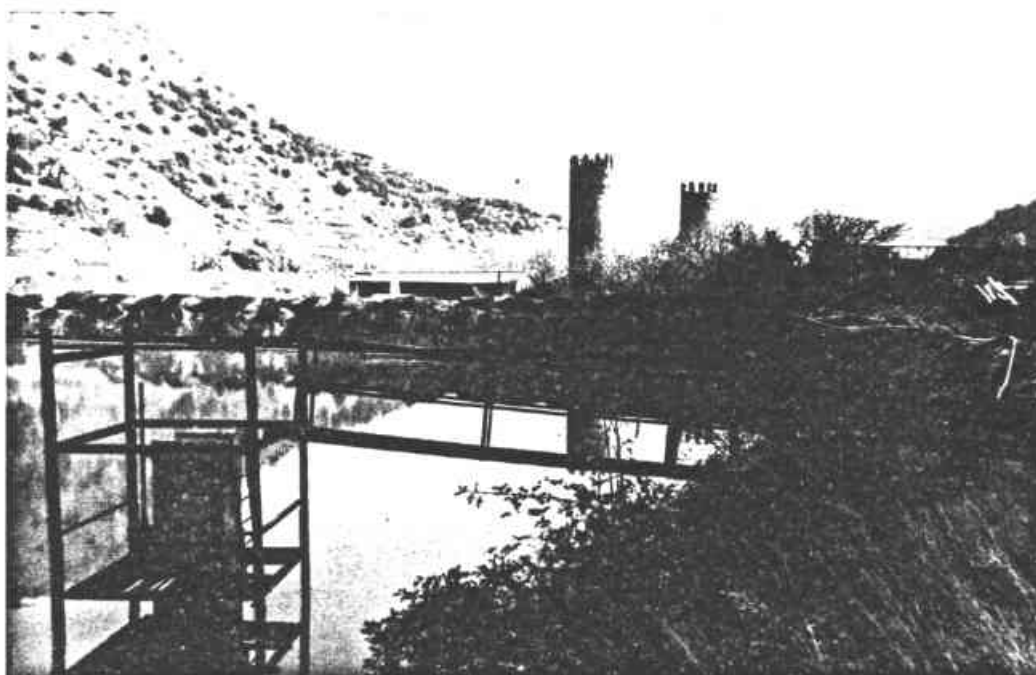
Bassin de décantation n° 4. Digue transversale et puits d'évacuation des eaux décantées.
